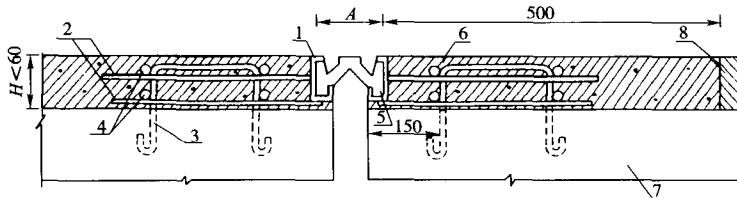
W 形伸缩装置横断面示意图(尺寸单位:mm)
